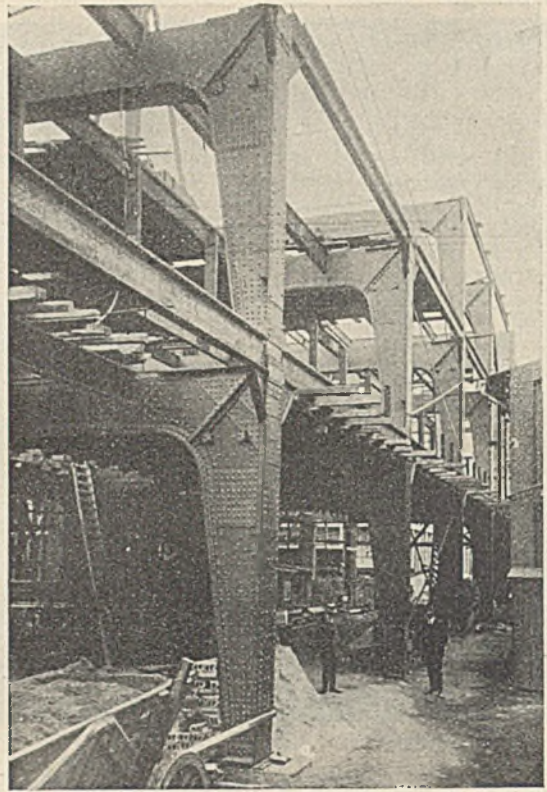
Fabrikgebäude in Kiel, Ansicht des Steifrahmen- Tragwerkes.
